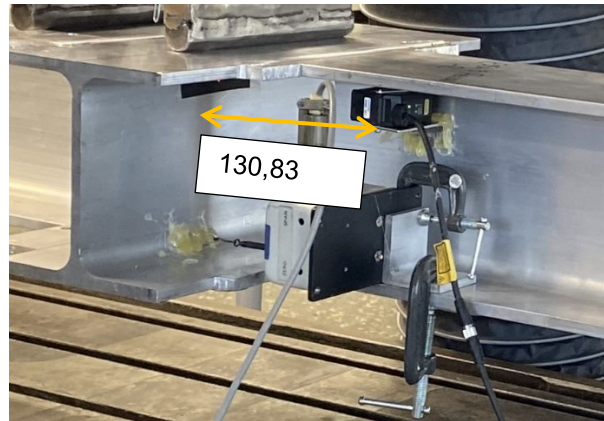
Capteur de déplacement laser placé horizontalement sur l'éprouvette à $L = 130,83$ mm
